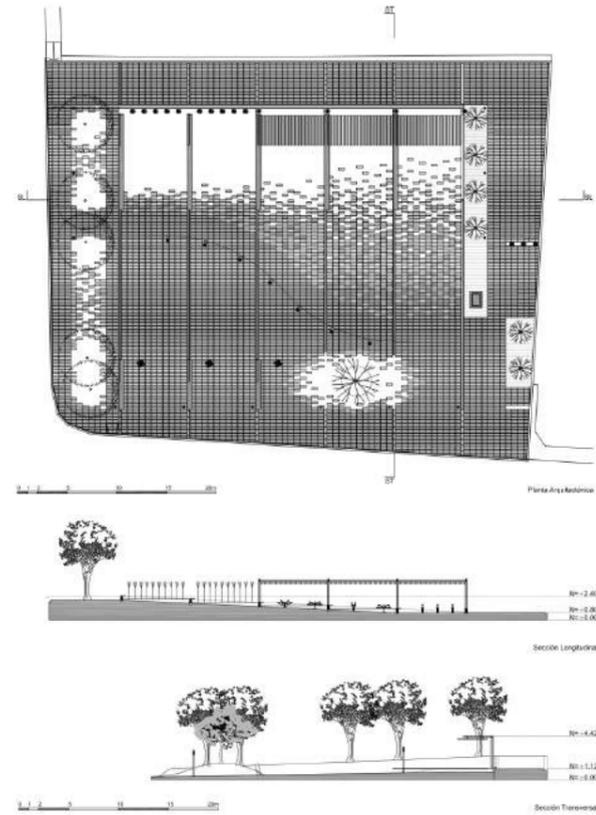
Planta arquitectónica y secciones de la Plaza Víctor J. Cuesta
